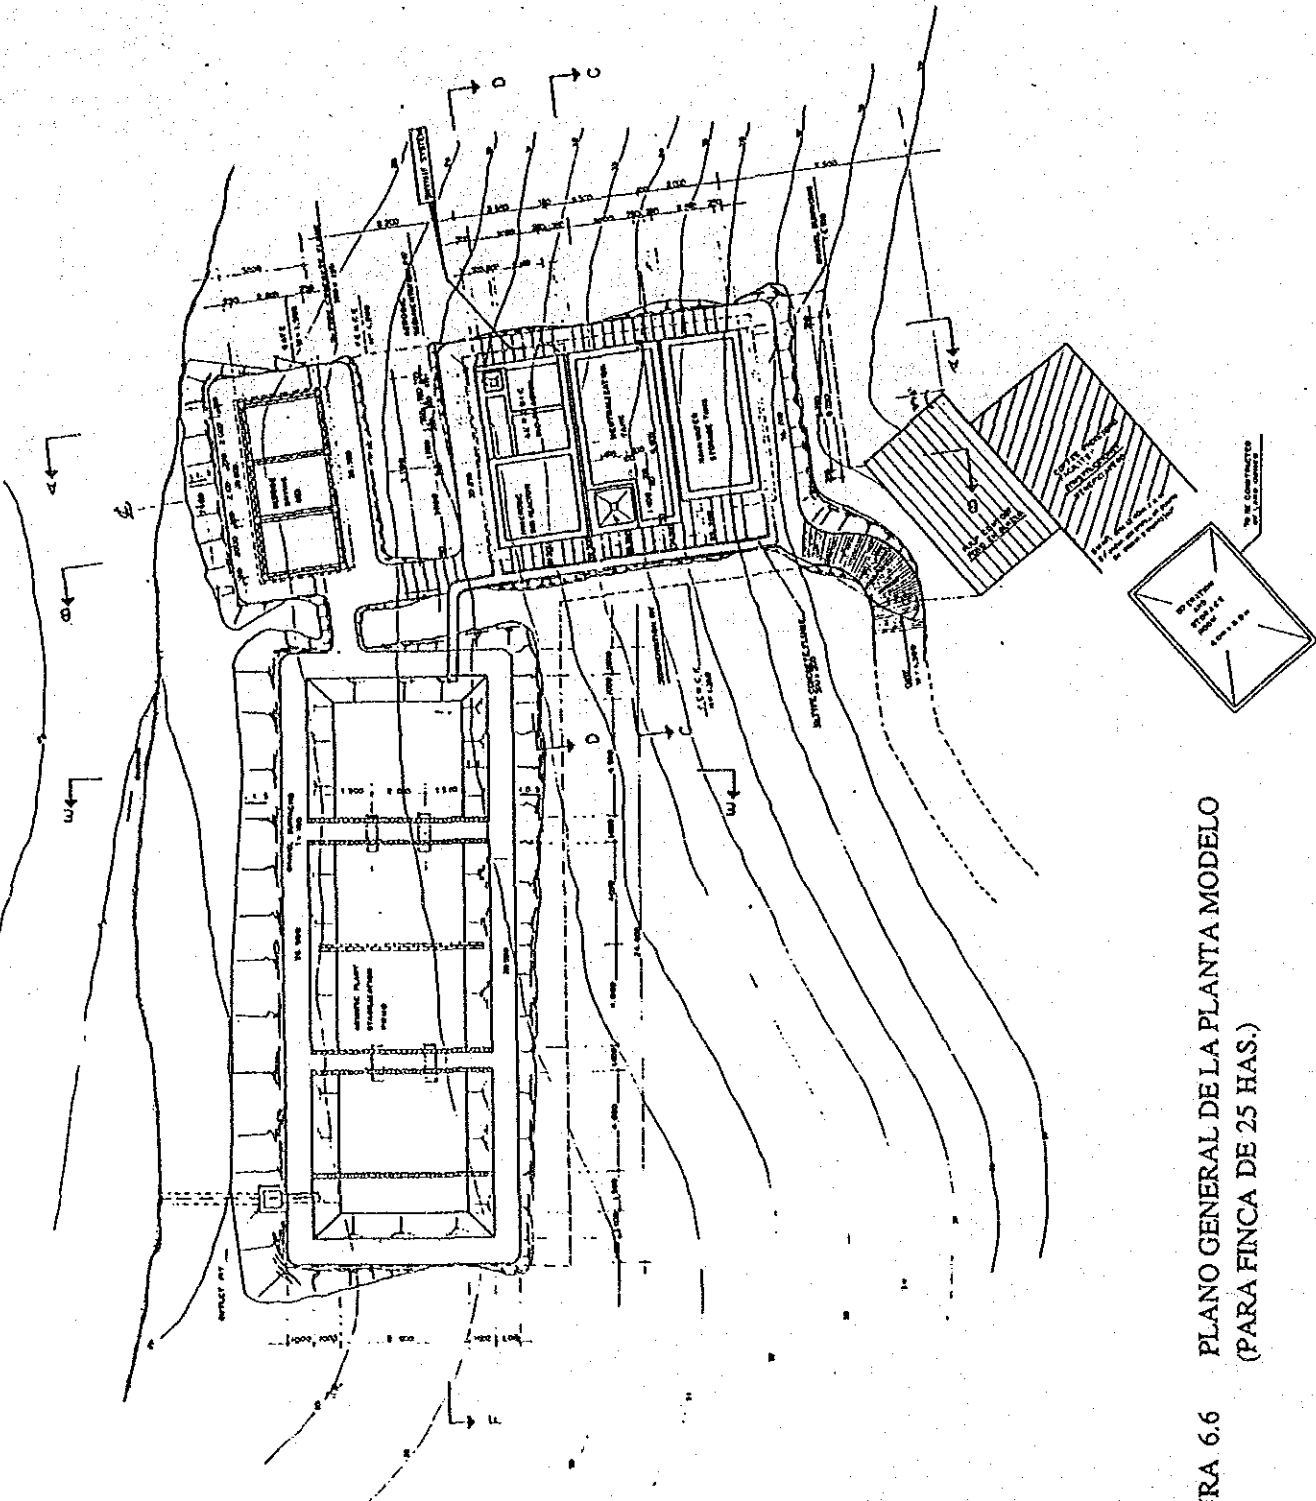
PLANO GENERAL DE LA PLANTA MODELO
